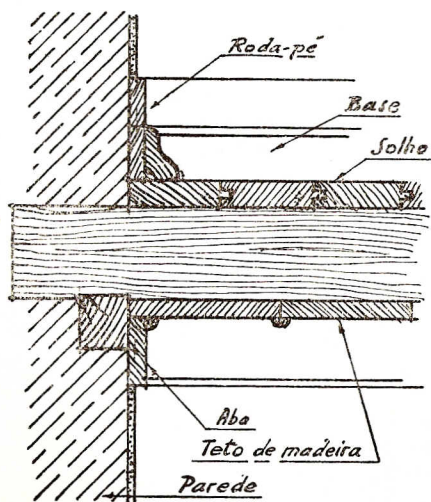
CORTE DE TECTO DE MADEIRA E DO PAVIMENTO SUPERIOR
